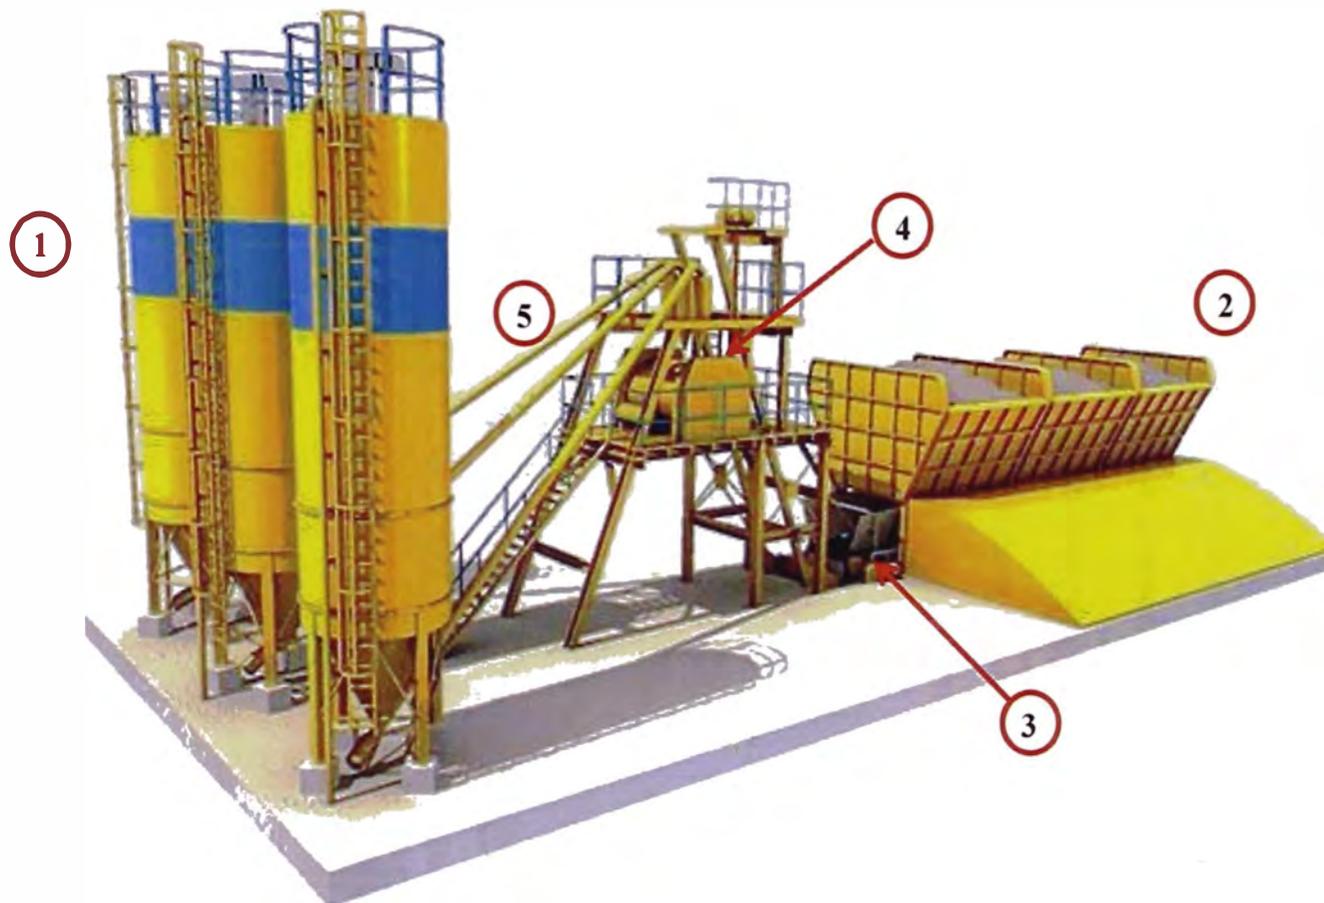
Principales componentes de una Planta de Concreto estacionaria
